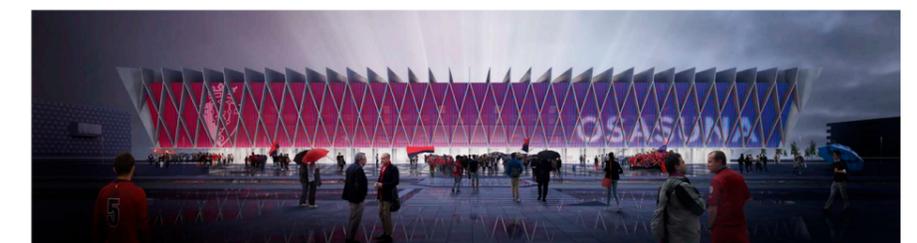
Renderización exterior, del alzado a pie de calle, de la propuesta.
